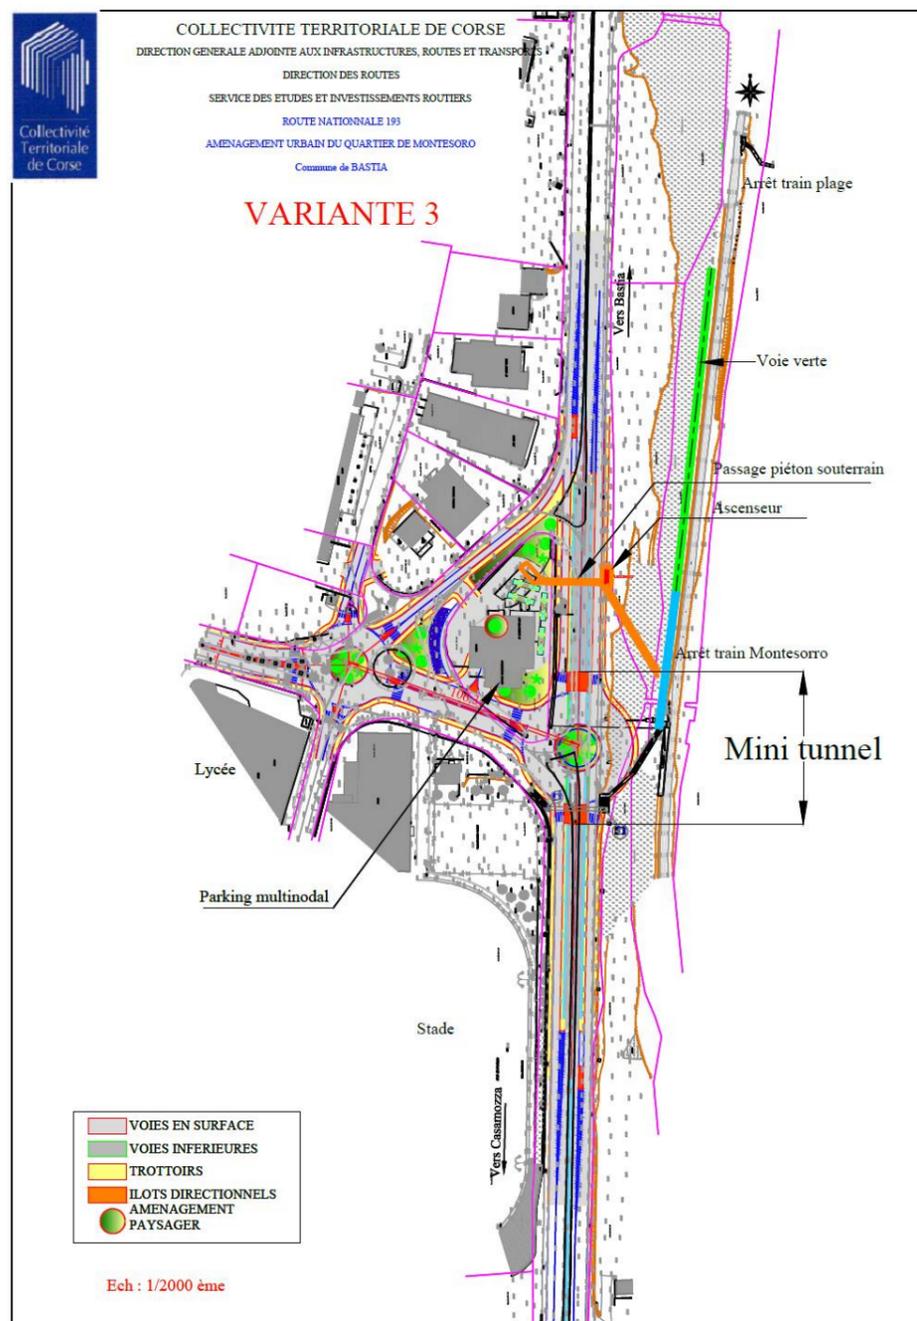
PLAN MASSE DE LA VARIANTE 3
